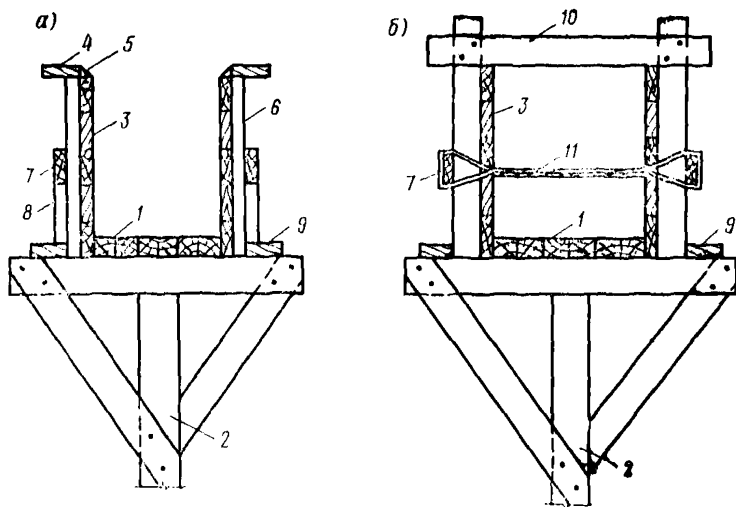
Схема опалубки железобетонных ригелей и балок из деревянных неинвентарных щитов
